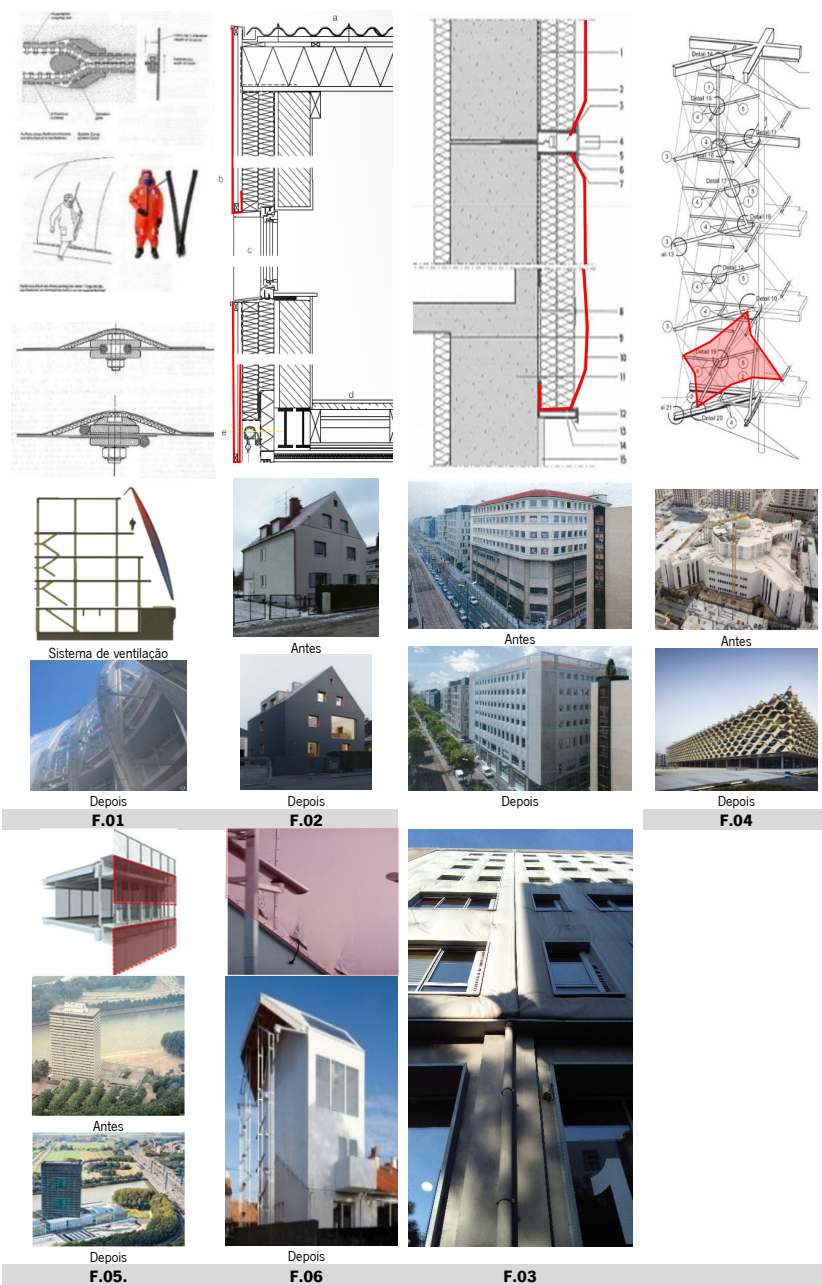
Pormenores de ligação entre a fachada em membrana e o edifício pré-existente.
